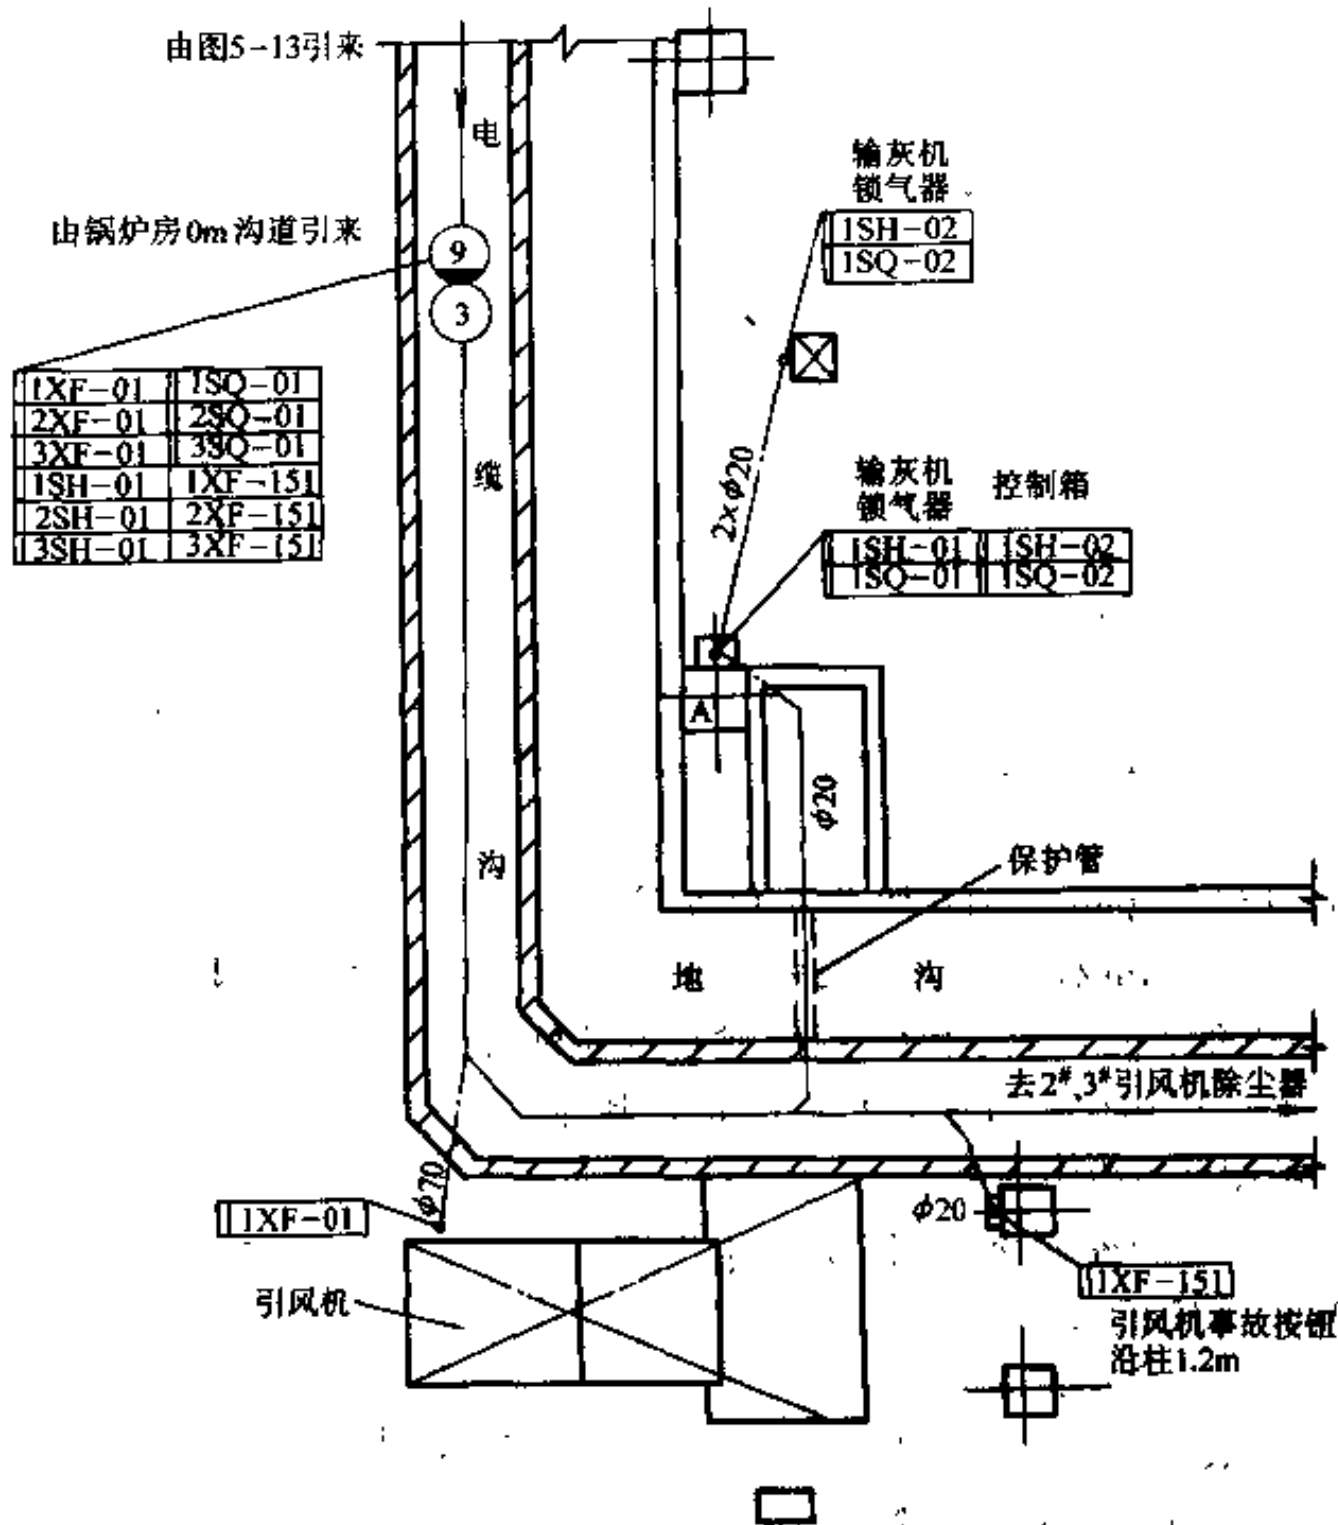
引风机除尘器场地电缆敷设平面图 (局部)
